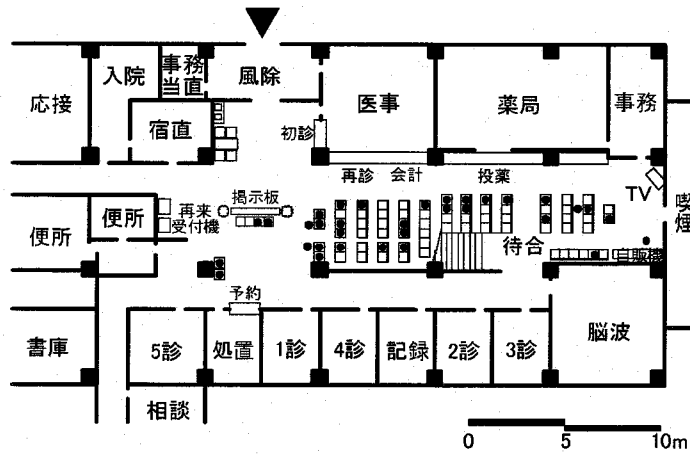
A病院1階精神科外来平面図 (2001.11.22 11:00)
